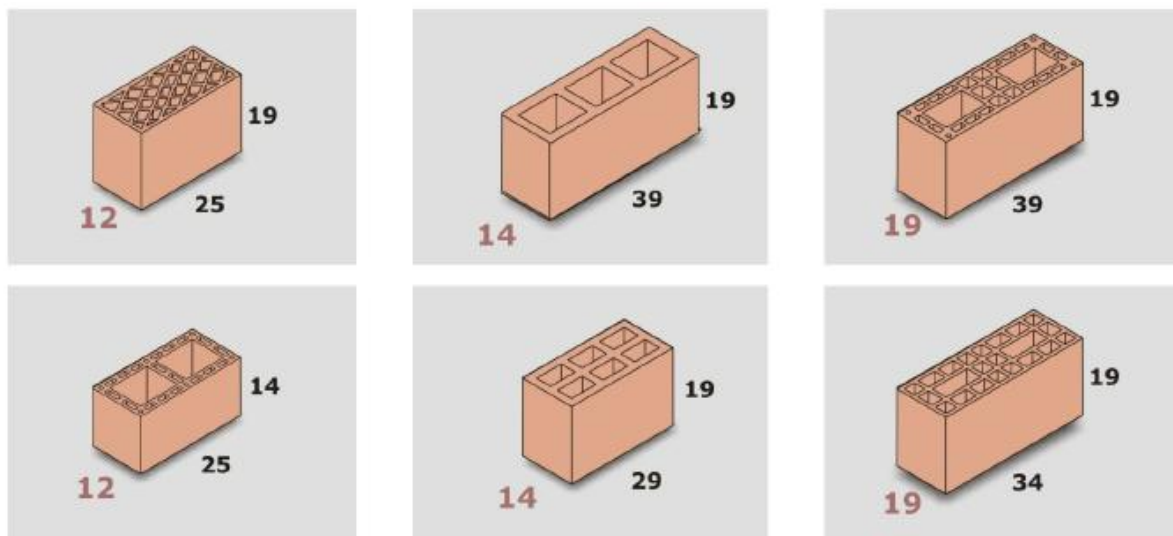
Exemplos de blocos cerâmicos estruturais utilizados na construção
